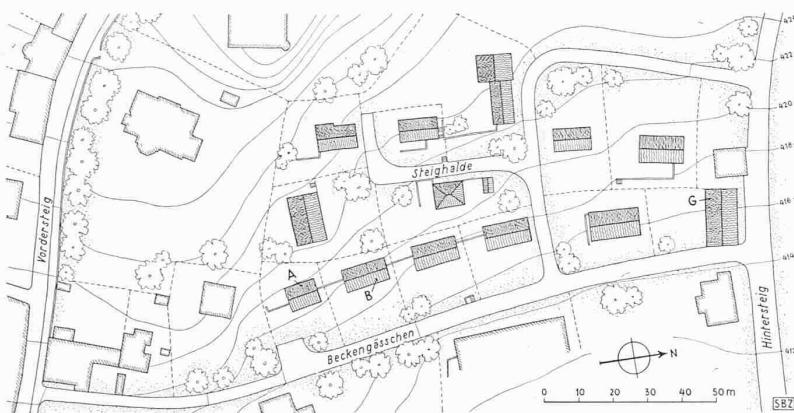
Lageplan der Steigsiedlung, Maßstab 1:2000
